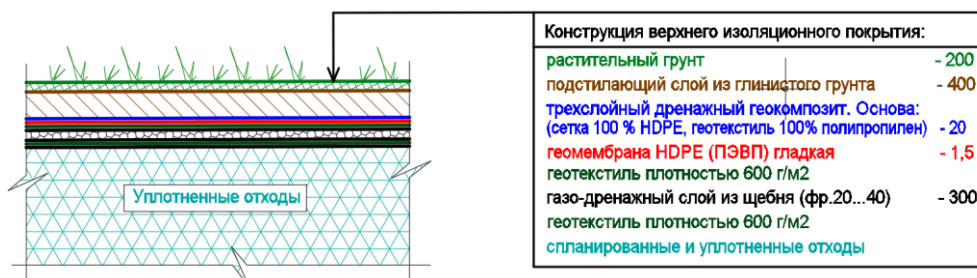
Разрез верхнего изоляционного покрытия
